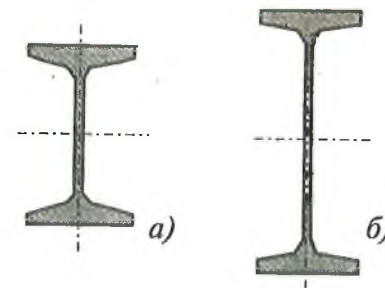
Сечения двутавровой балки без горизонтального усиления
